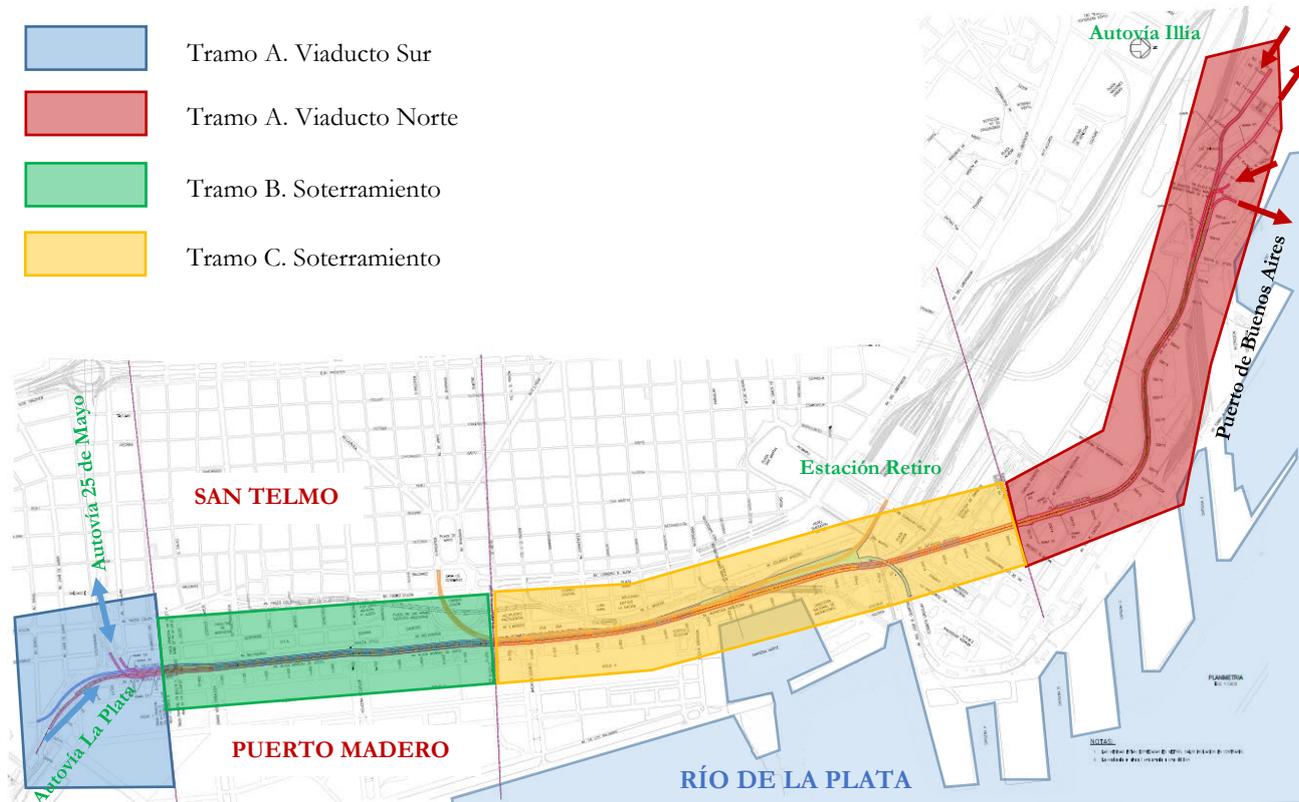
Vista en planta de la Actuación del Proyecto del Bajo
